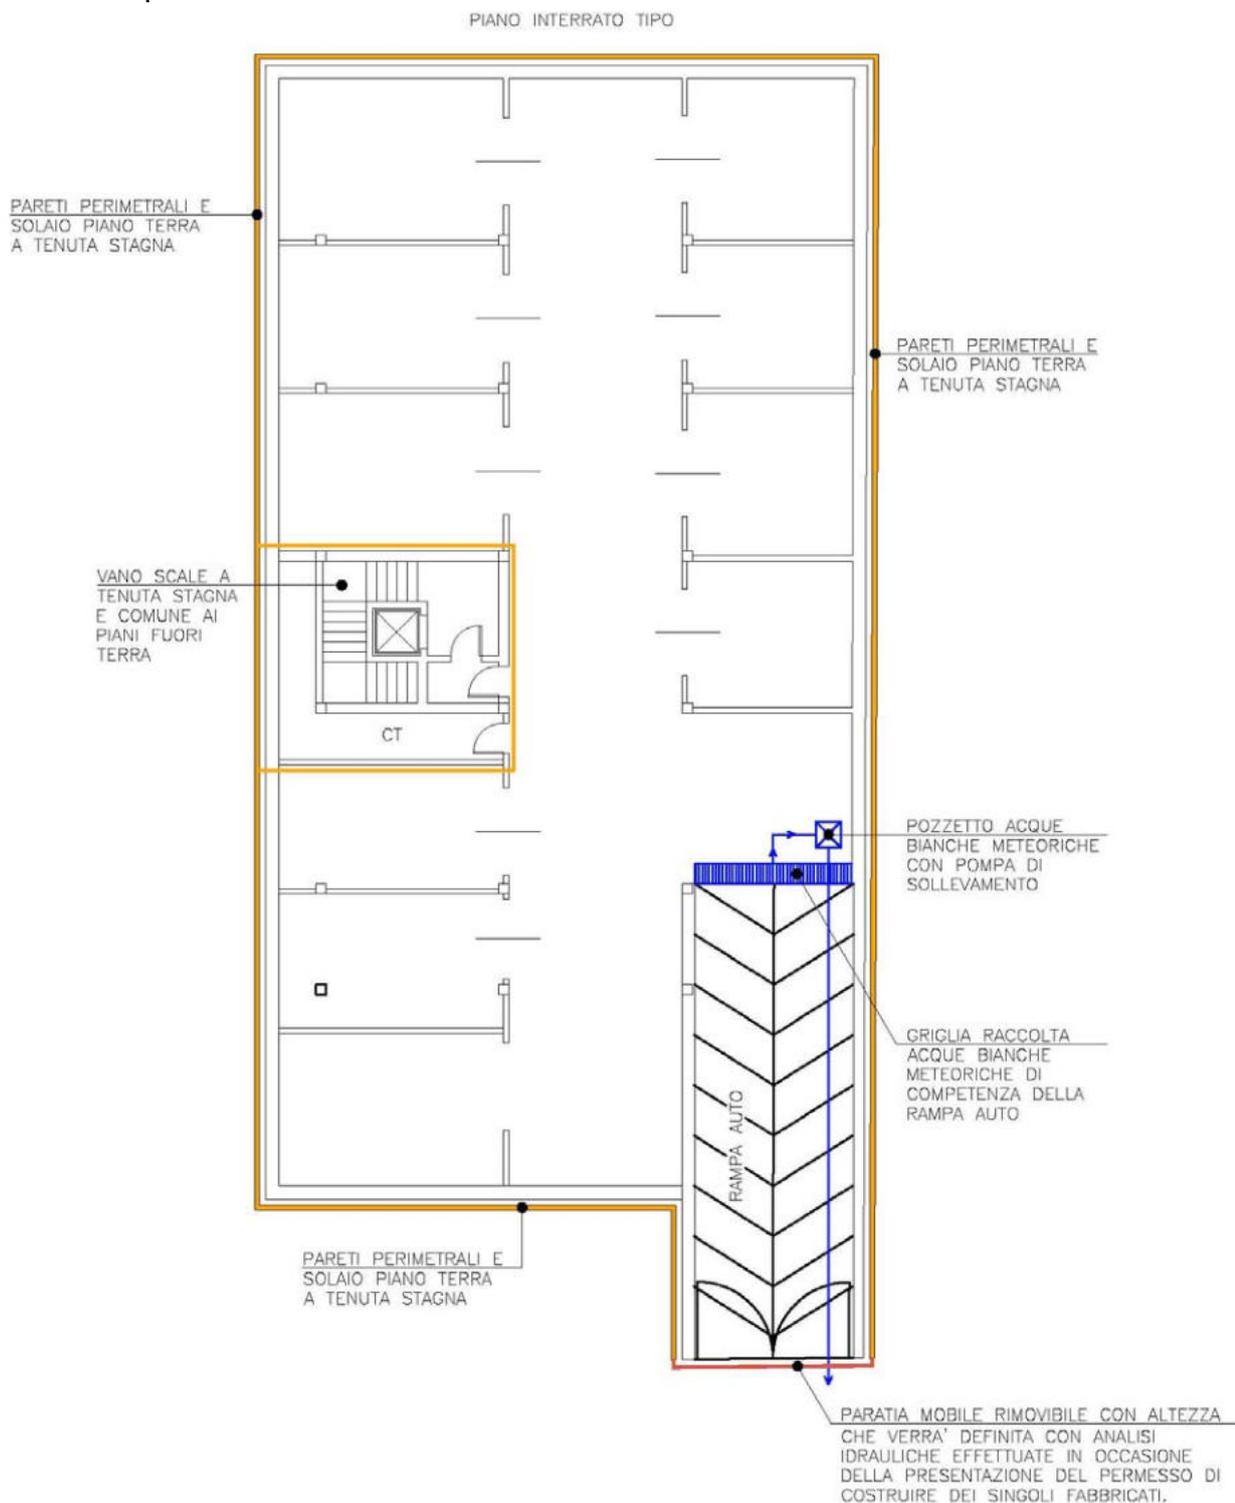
Schema indicativo tipo dei sistemi di sicurezza contro allagamento piani interrati
